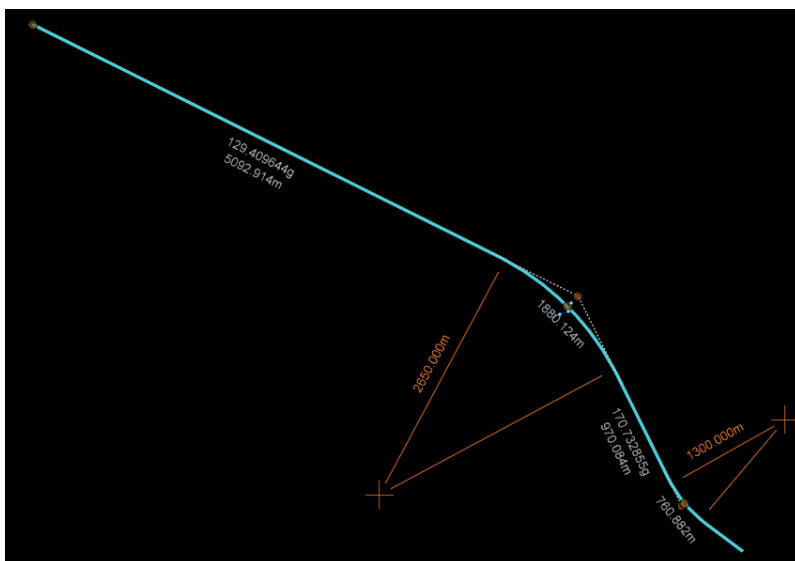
Tracciato planimetrico definitivo attraverso OpenRail Designer.
